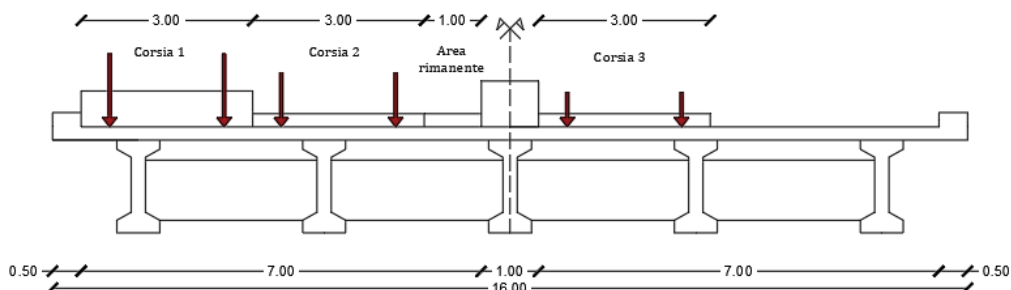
Disposizione trasversale dei carichi da traffico
